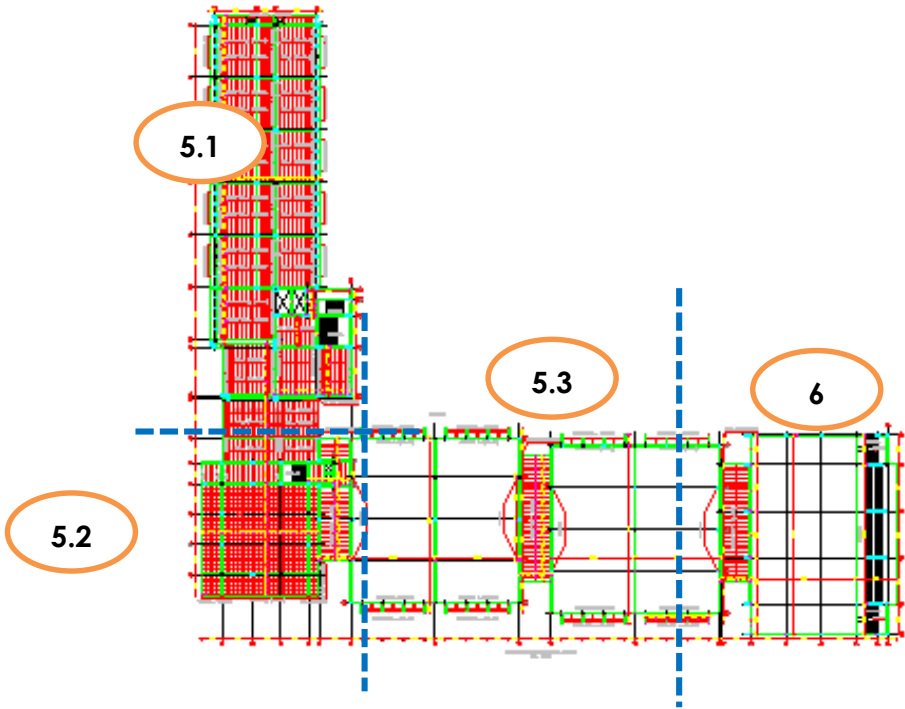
planta de segundo nivel y cubiertas de las estructuras 5.1, 5.2, 5.3 y 6
